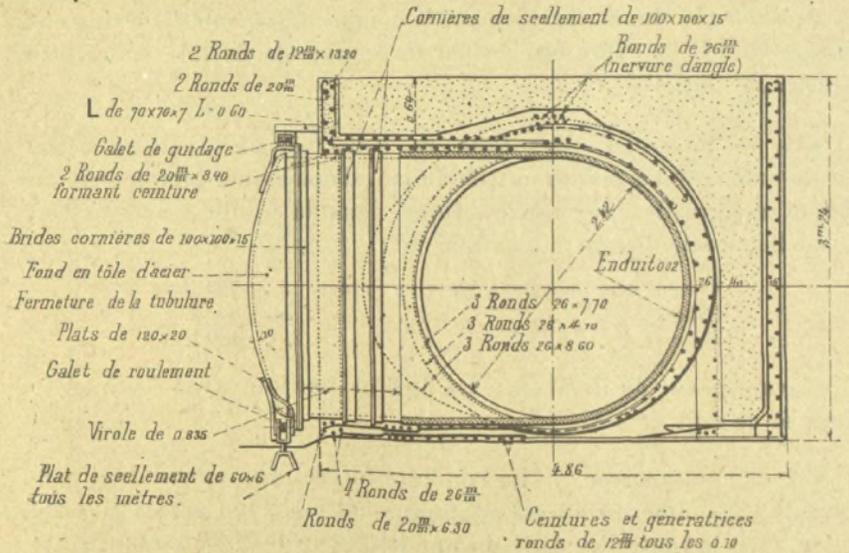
Conduite à la traversée du bief de l'OEuf. Coupe ef.
